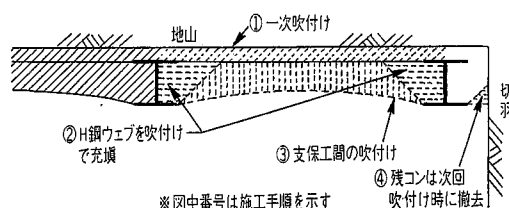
鋼製支保工周りの吹付けコンクリートの施工手順
